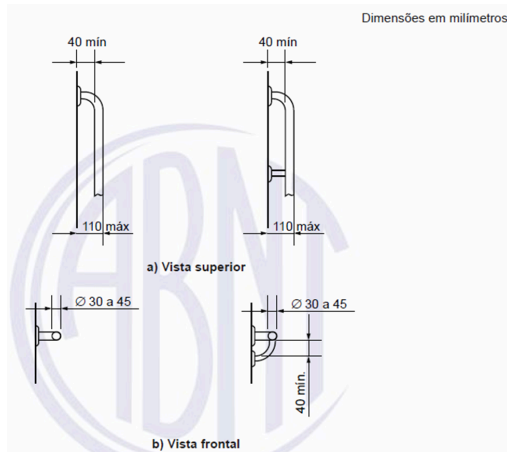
Seção transversal das barras de apoio internas do sanitário (NBR 9050/2020).
